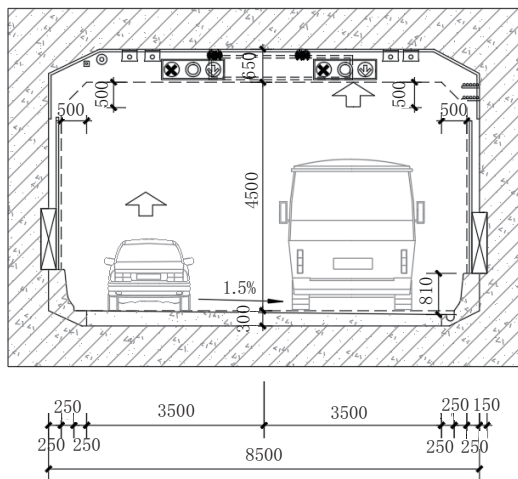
匝道Z1和Z2暗埋段横断面图(单位:mm)
